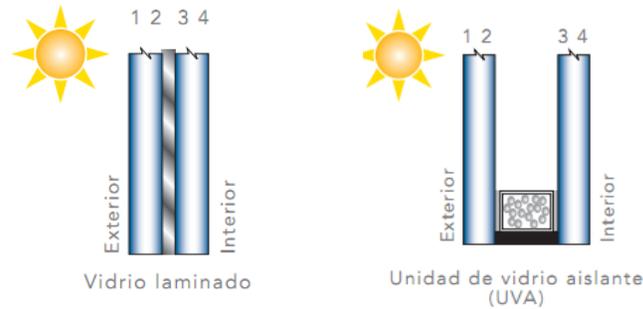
Esquemas de vidrios laminados para uso en fachadas.
